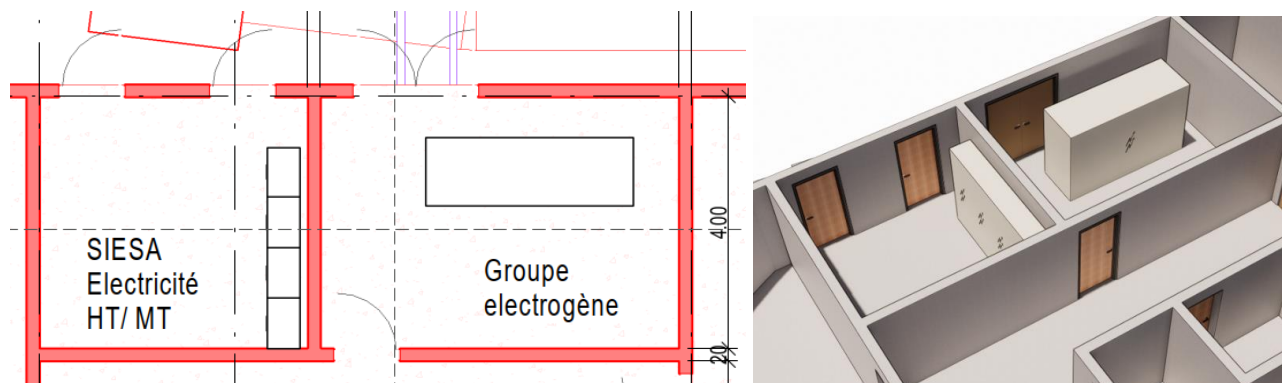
Plan d'installation des locaux électriques (moyenne tension)
